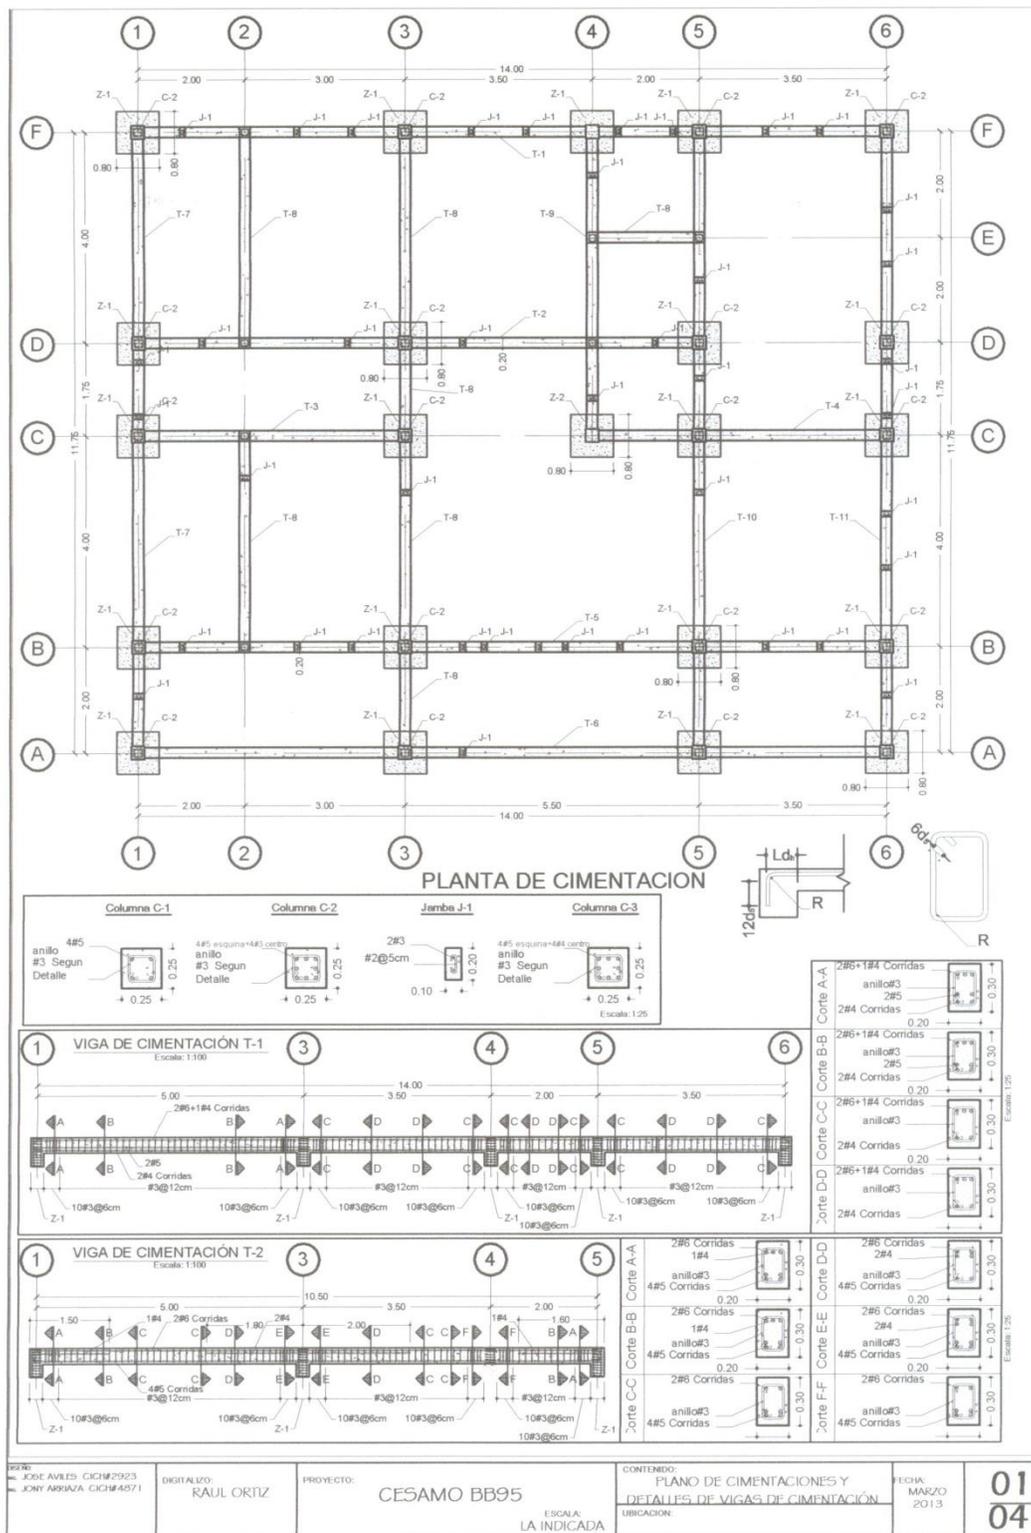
Plano Estructural de Cimentación CESAMO Tipo I Nivel 12X14m.
